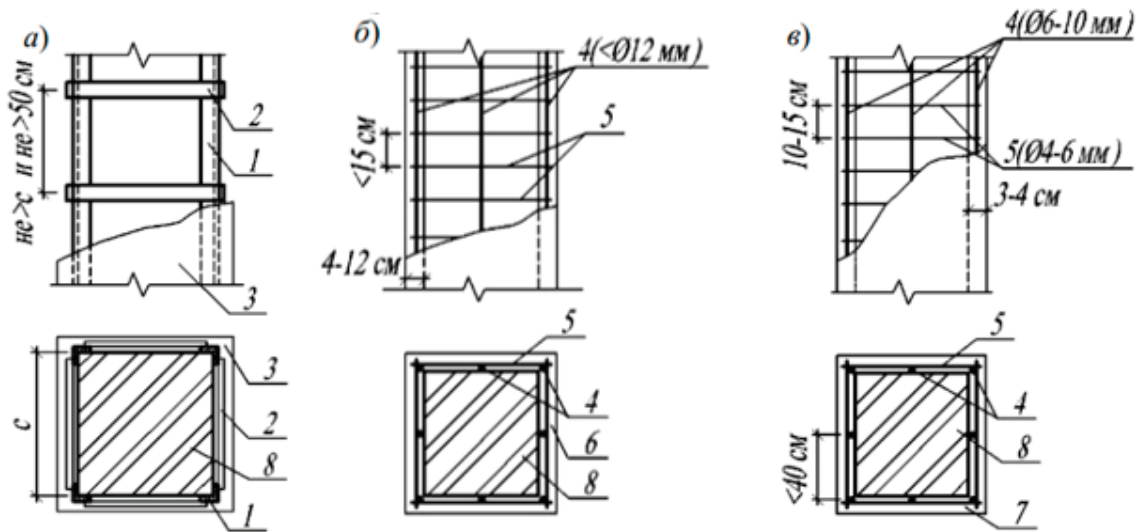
Схемы усиления кирпичных конструкций стальной (а), железобетонной (б) и растворной (в) обоями: 1 — стальные уголки; 2 — планки (хомуты); 3 — защитный слой раствора; 4 — продольная арматура; 5 — хомуты; 6 — бетон обоймы; 7 — раствор обоймы; 8 — кирпичный столб (простенок)
